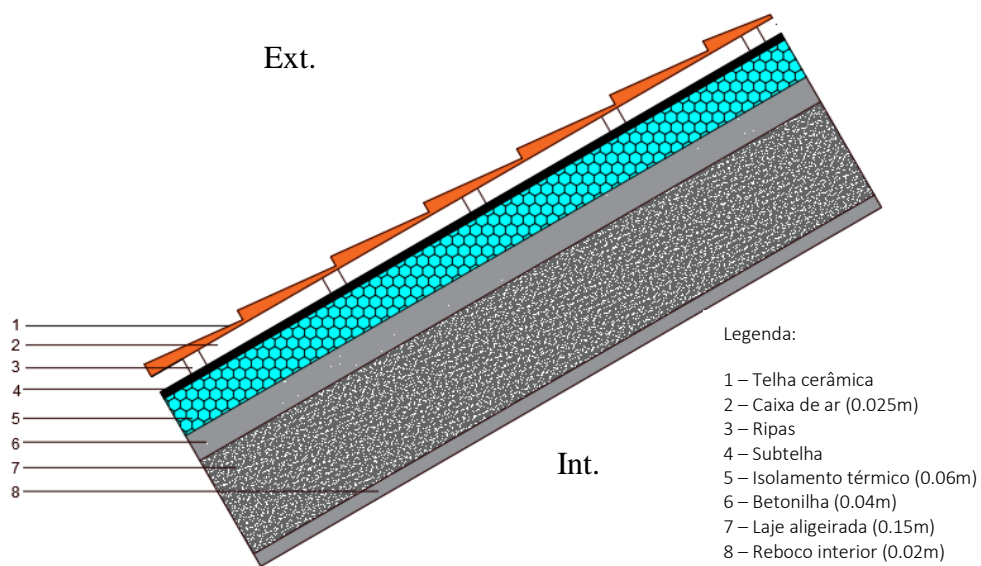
Pormenor construtivo referente à solução construtiva isolamento na vertente inclinada na face superior
